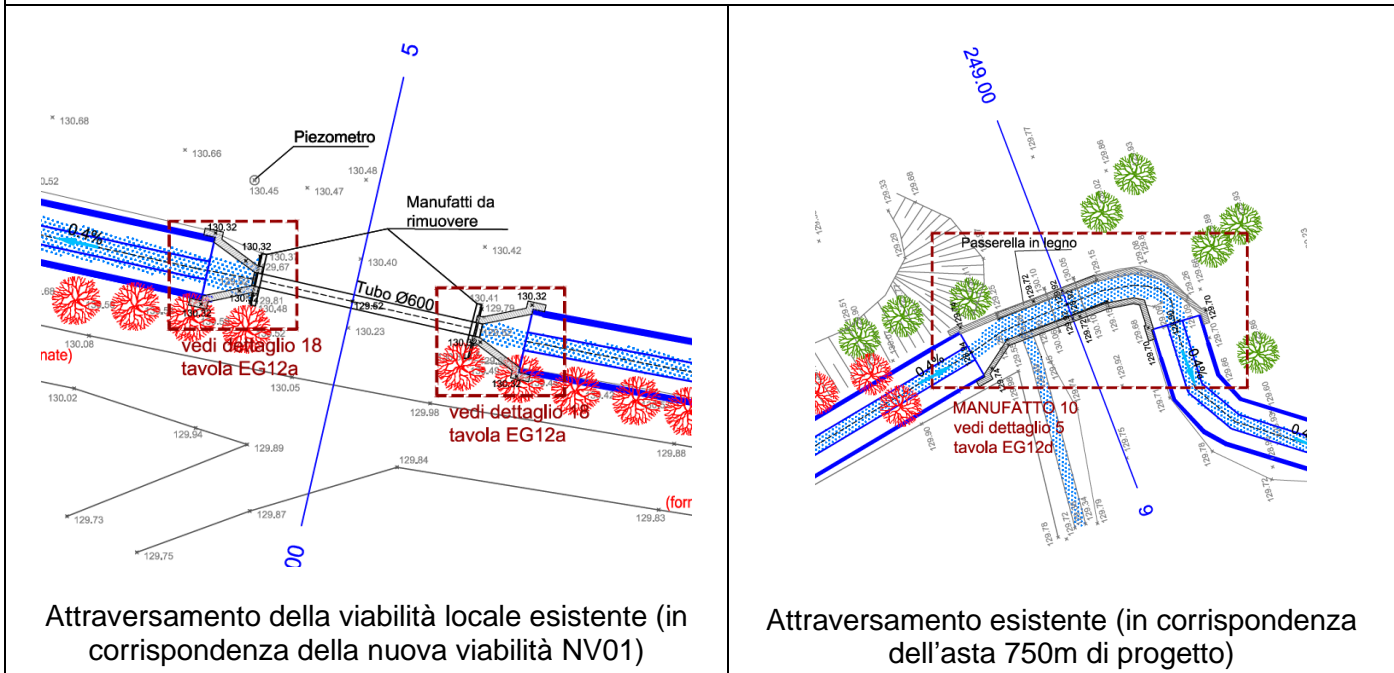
Estratto tavola LOM1603_PE_EG008h_2 "interventi di progetto planimetria tratto 4i" - Progetto messa in sicurezza d'emergenza delle rogge ricomprese nel SIN di Brescia Caffaro - Stralcio 1
